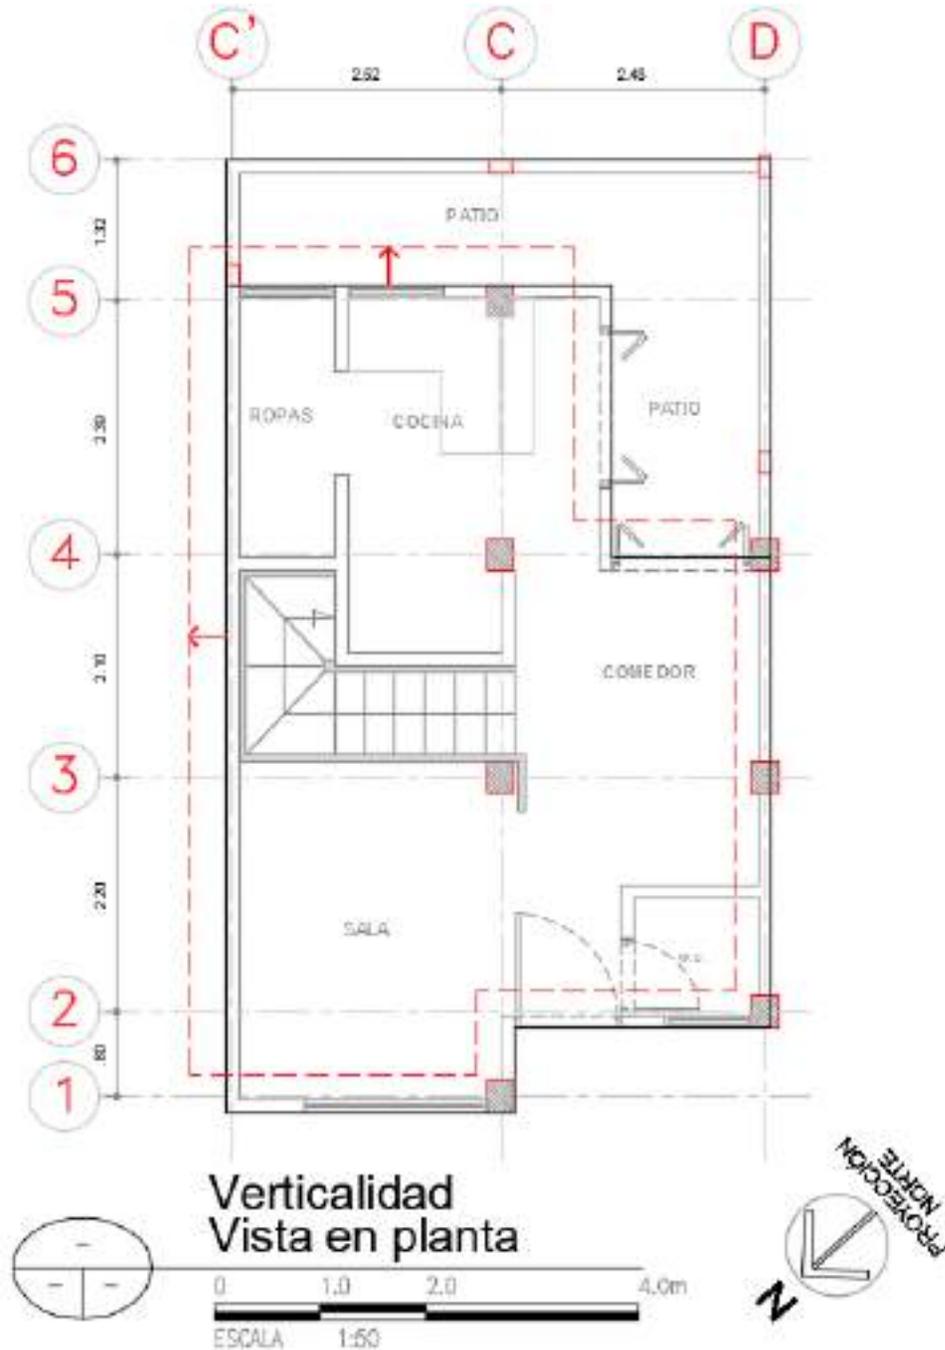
Plata de ubicación de verticalidad vista en planta.
